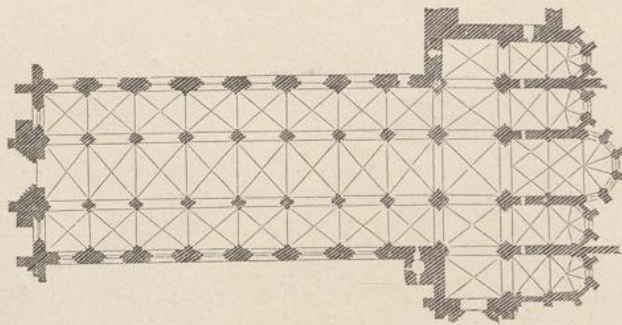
Grundriß der Klosterkirche zu Batalha.
